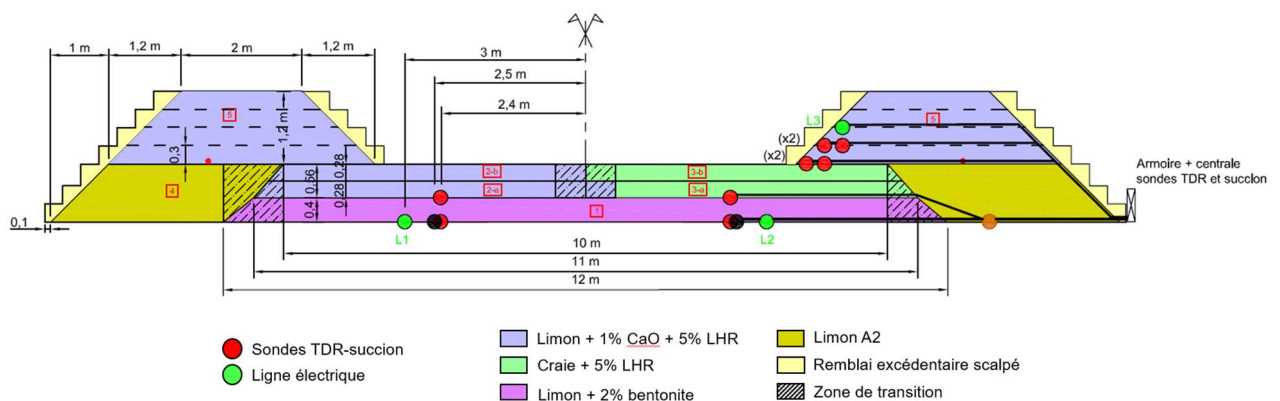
Coupe du bassin et schéma d'instrumentation des planches d'essais.
